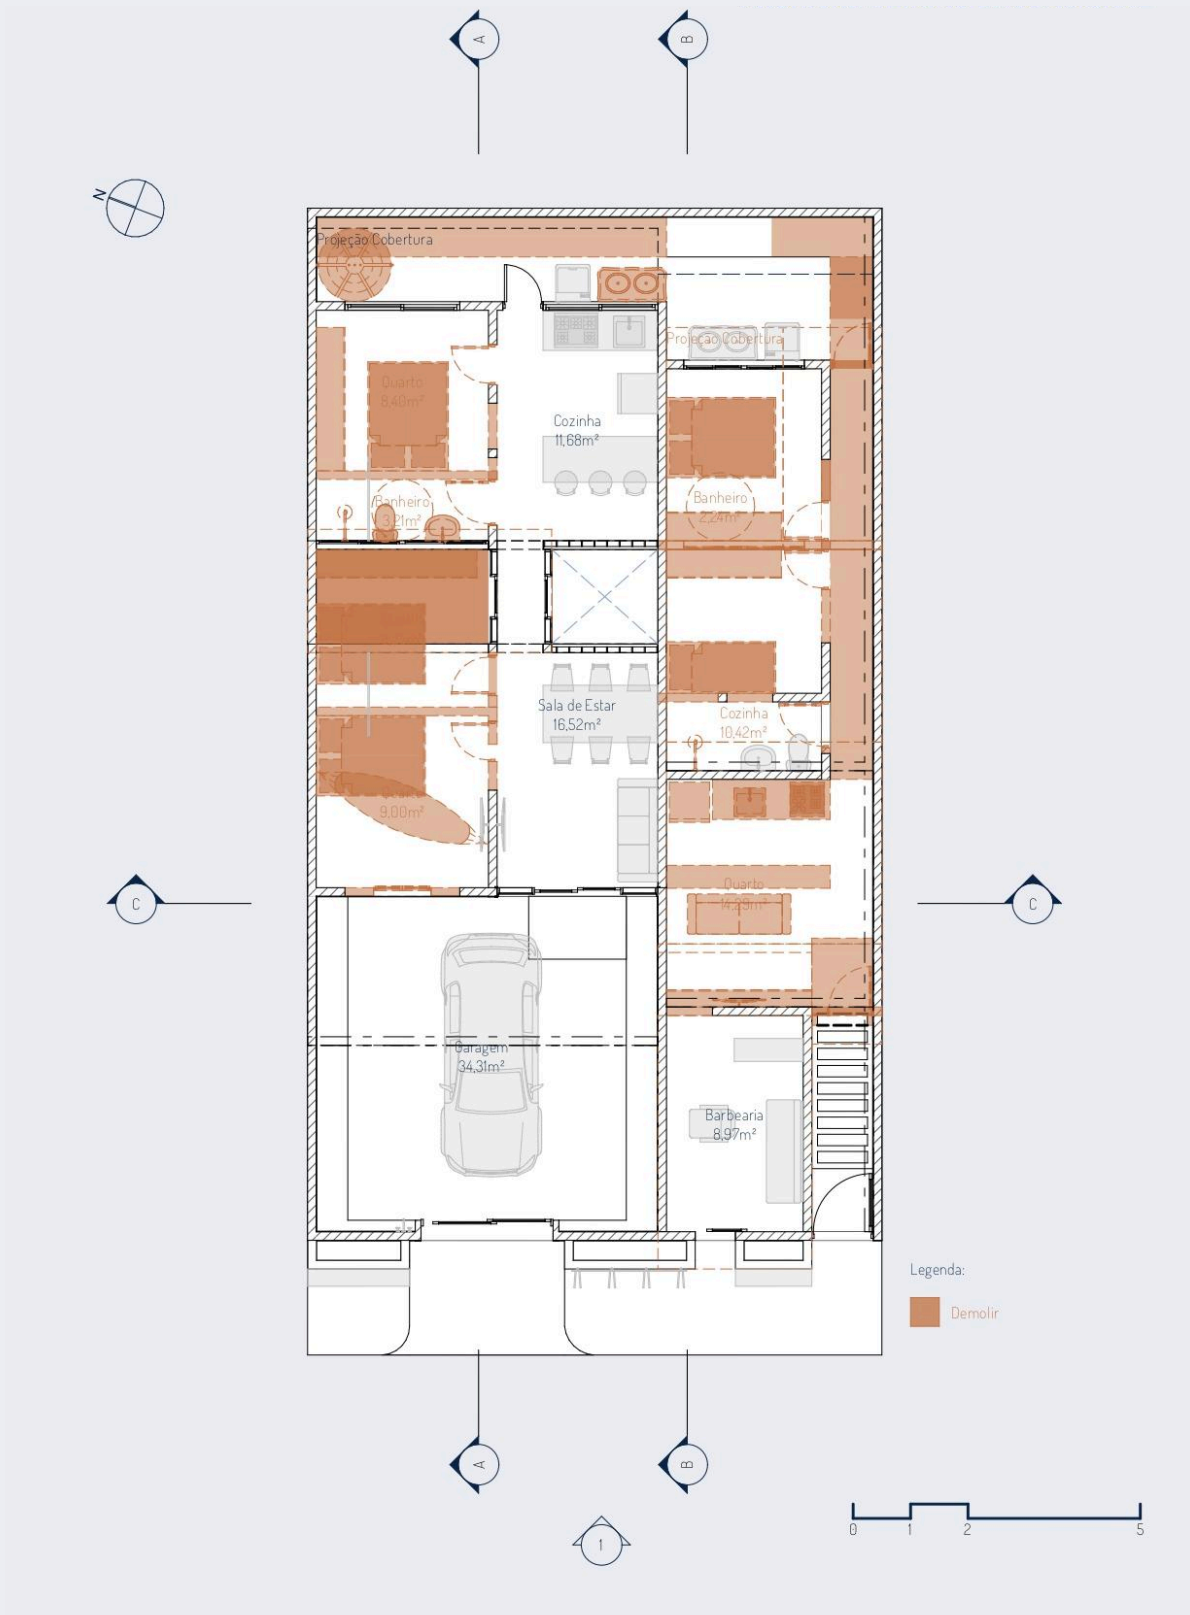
Planta do existente da Casa 349, considerando o Cenário Possível
